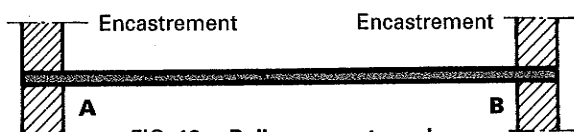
Dalle reposant sur deux murs avec encastrement à chaque extrémité.
